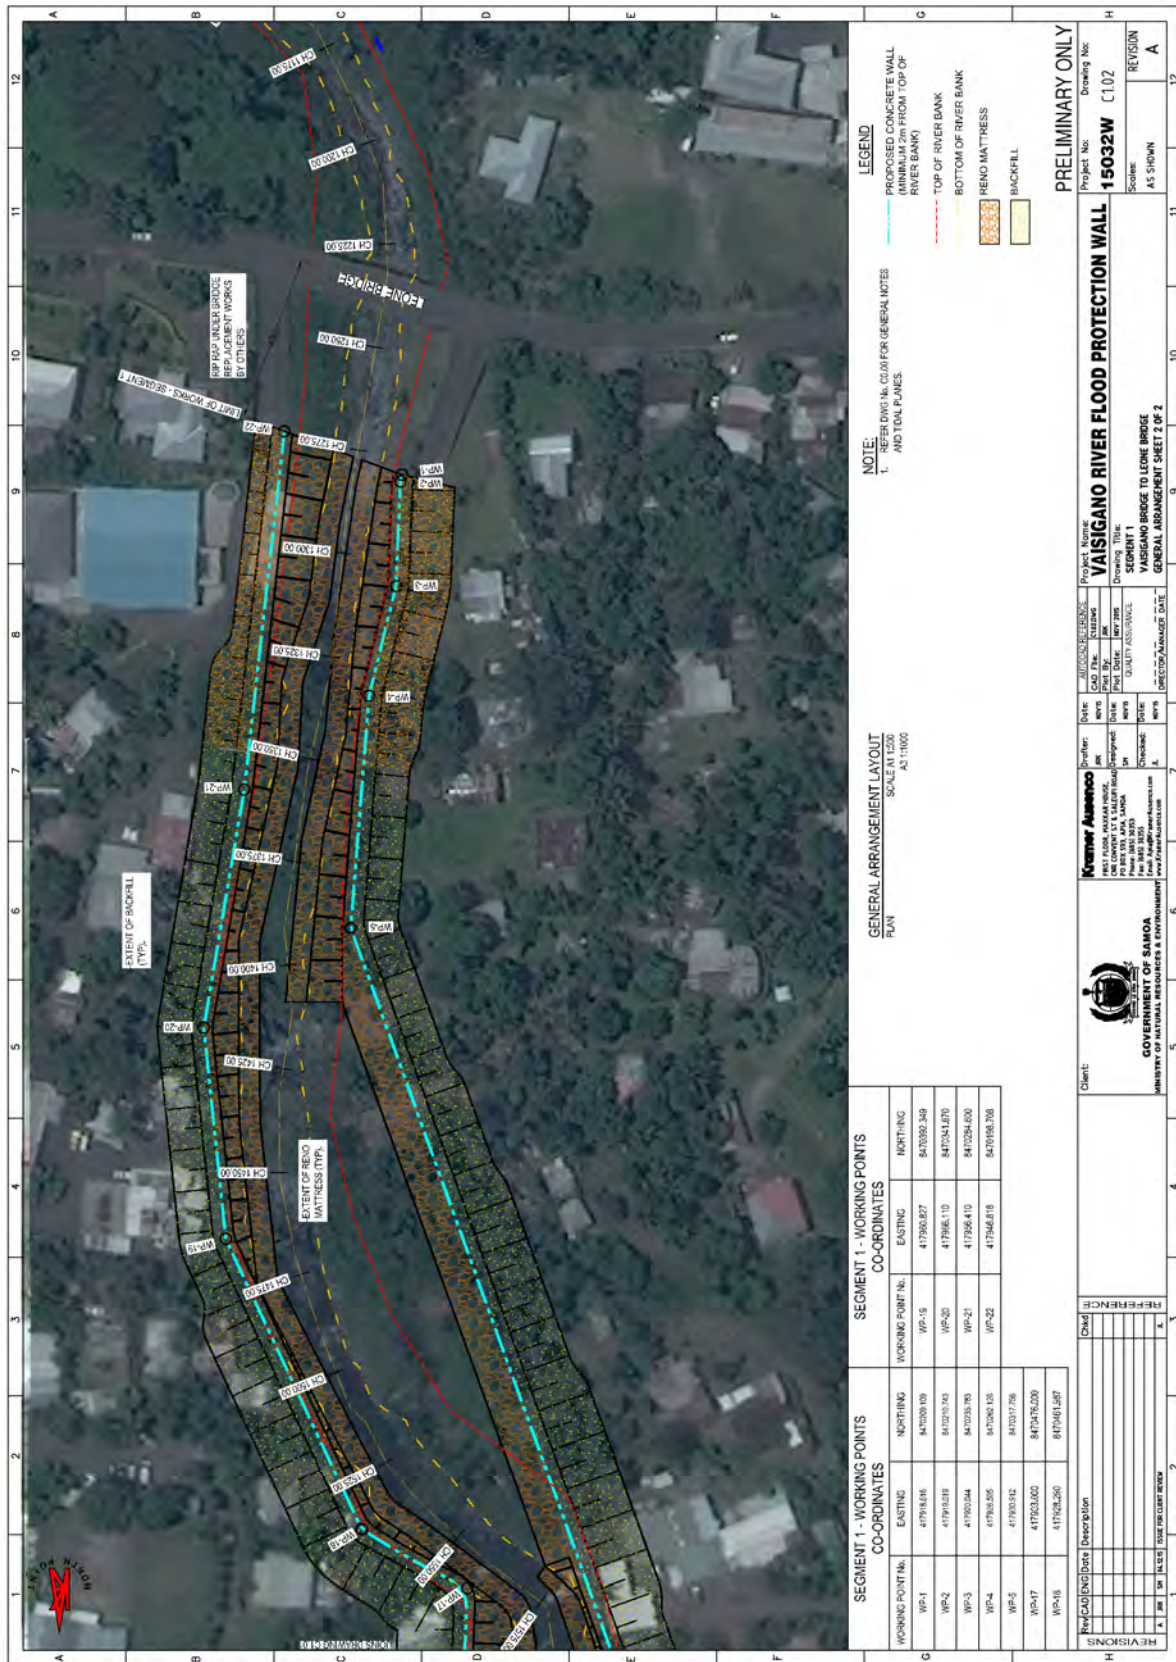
ヴァイシガノ川護岸整備計画平面図 (3/3)
